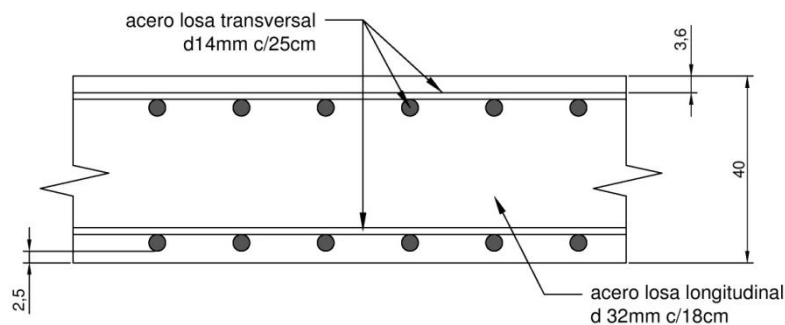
Distribución de aceros en la losa. Vista Frontal.
